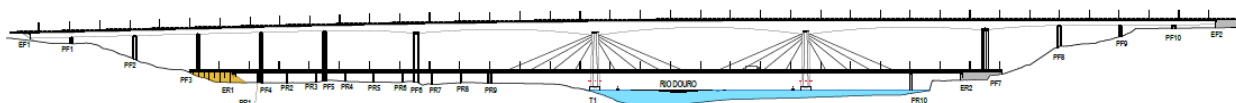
Faseamento construtivo – Etapa 6 de 6
